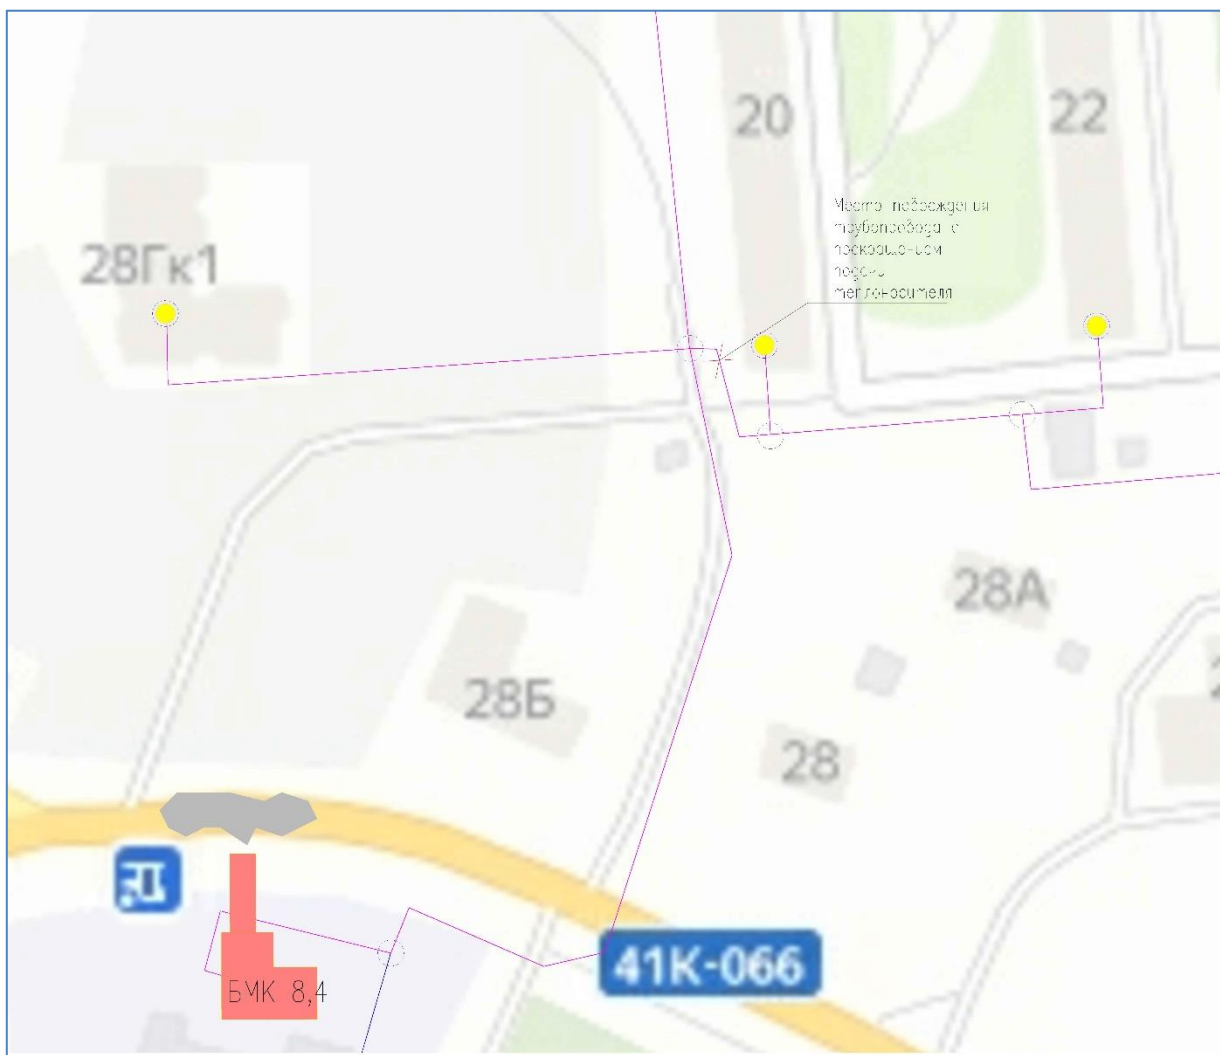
Повреждение участка трубопровода перед домом № 20.
